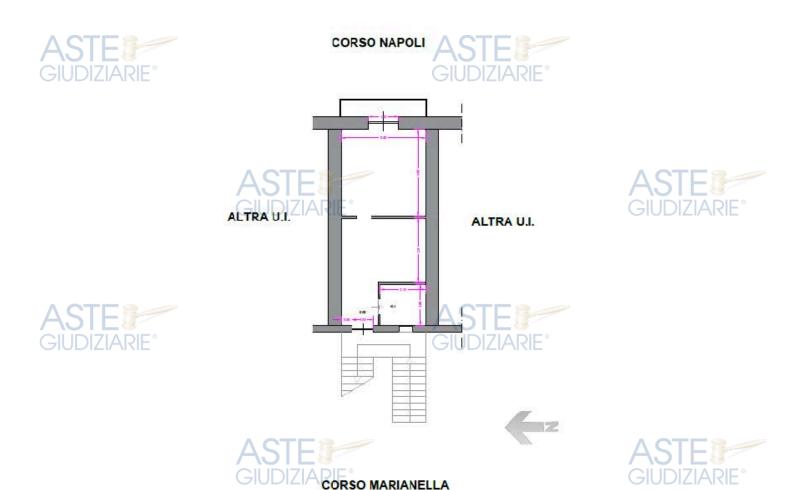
Planimetria dello stato attuale dei luoghi
